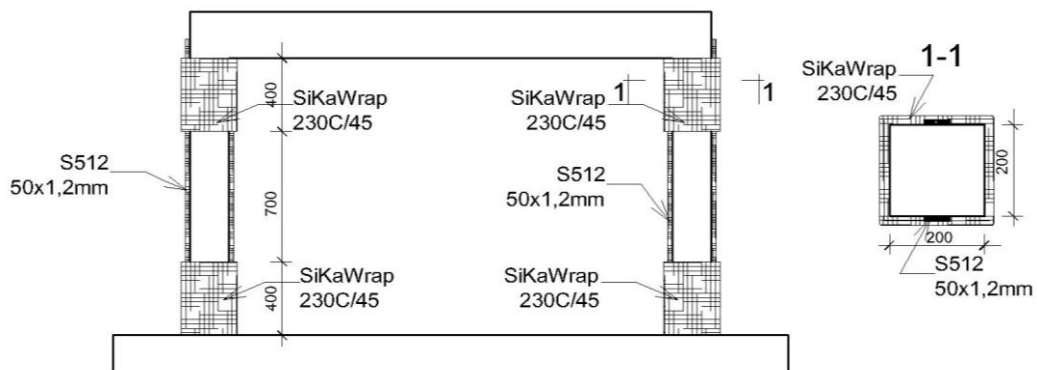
Aplicarea materialelor CFRP la cadrul din beton armat
